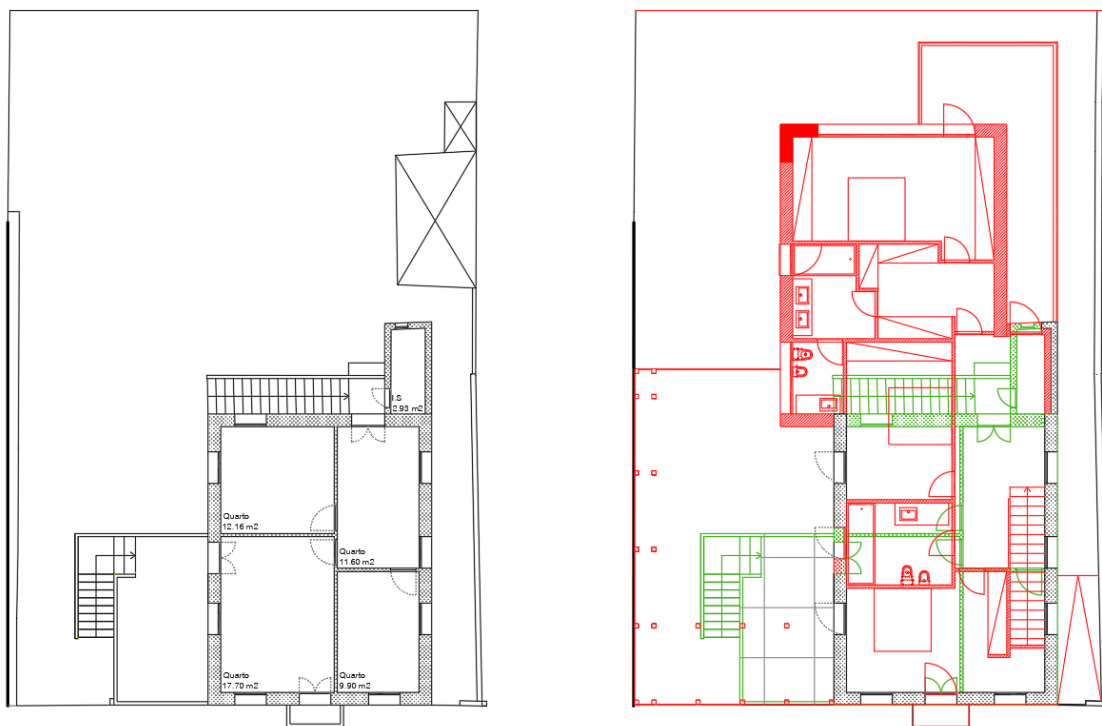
Piso elevado planta antiga e piso elevado planta alterada (Projeto de arquitetura).
